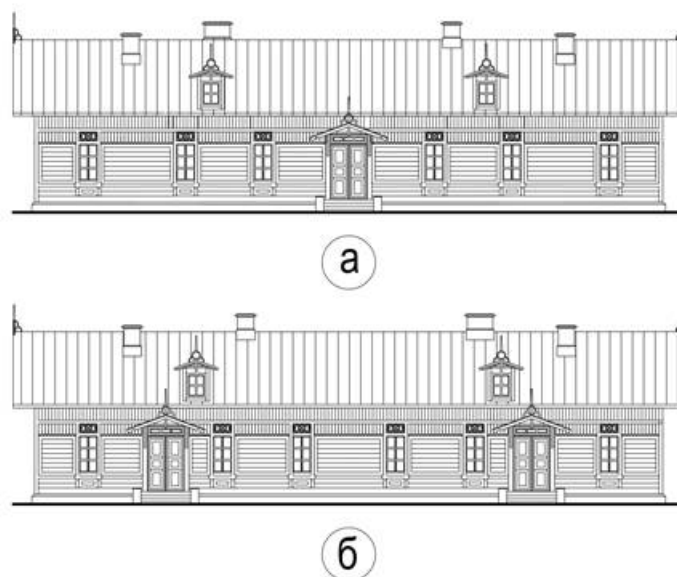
Фасады дома начальника депо: а) главный фасад, ориентированный на улицу Вокзальную; б) фасад, ориентированный на железнодорожные пути (реконструкция автора по фотографии)
